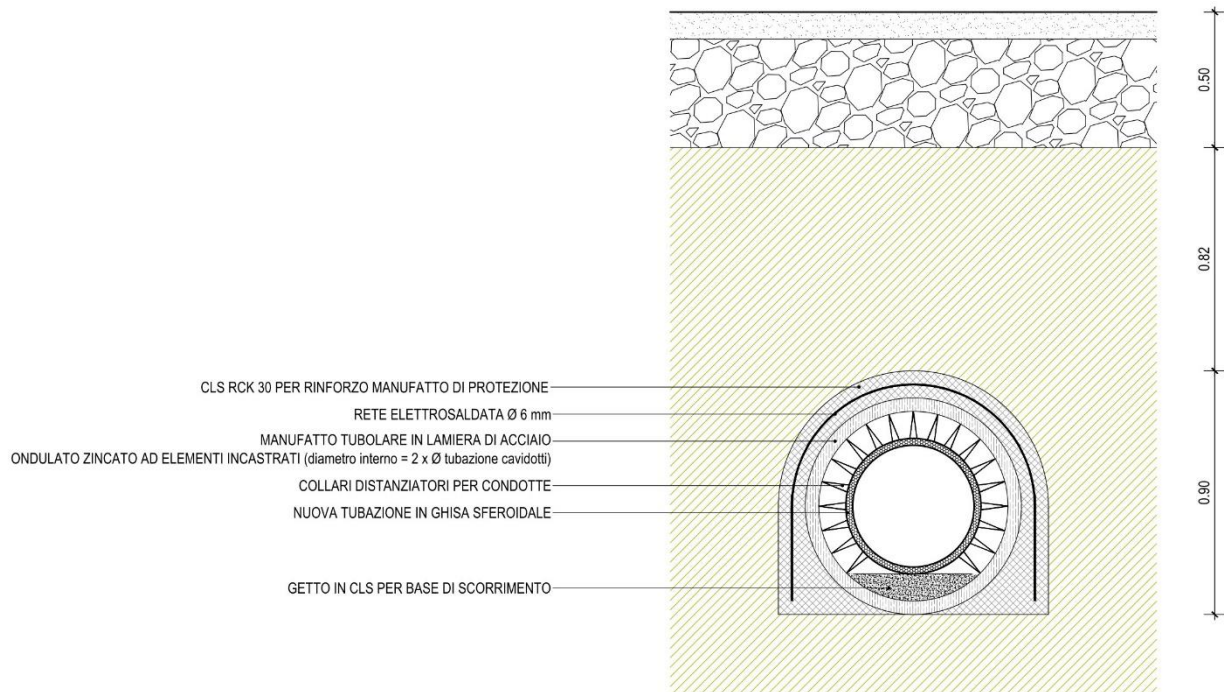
Dettaglio attraversamento di condotte irrigue
